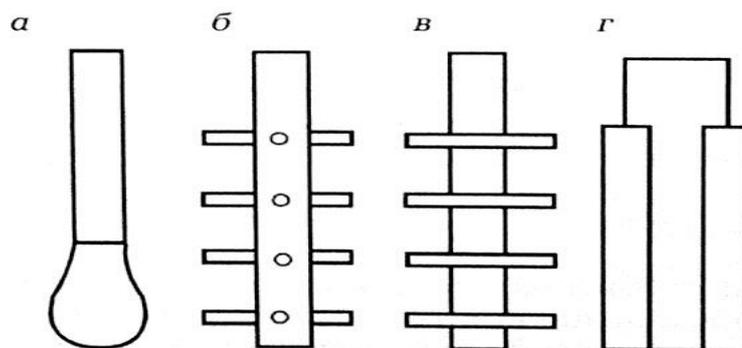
Конструкции анодного заземлителя: а – с утолщенным низом; б – с приваренными штырями; в – с приваренными дисками; г – с приваренными полосами
